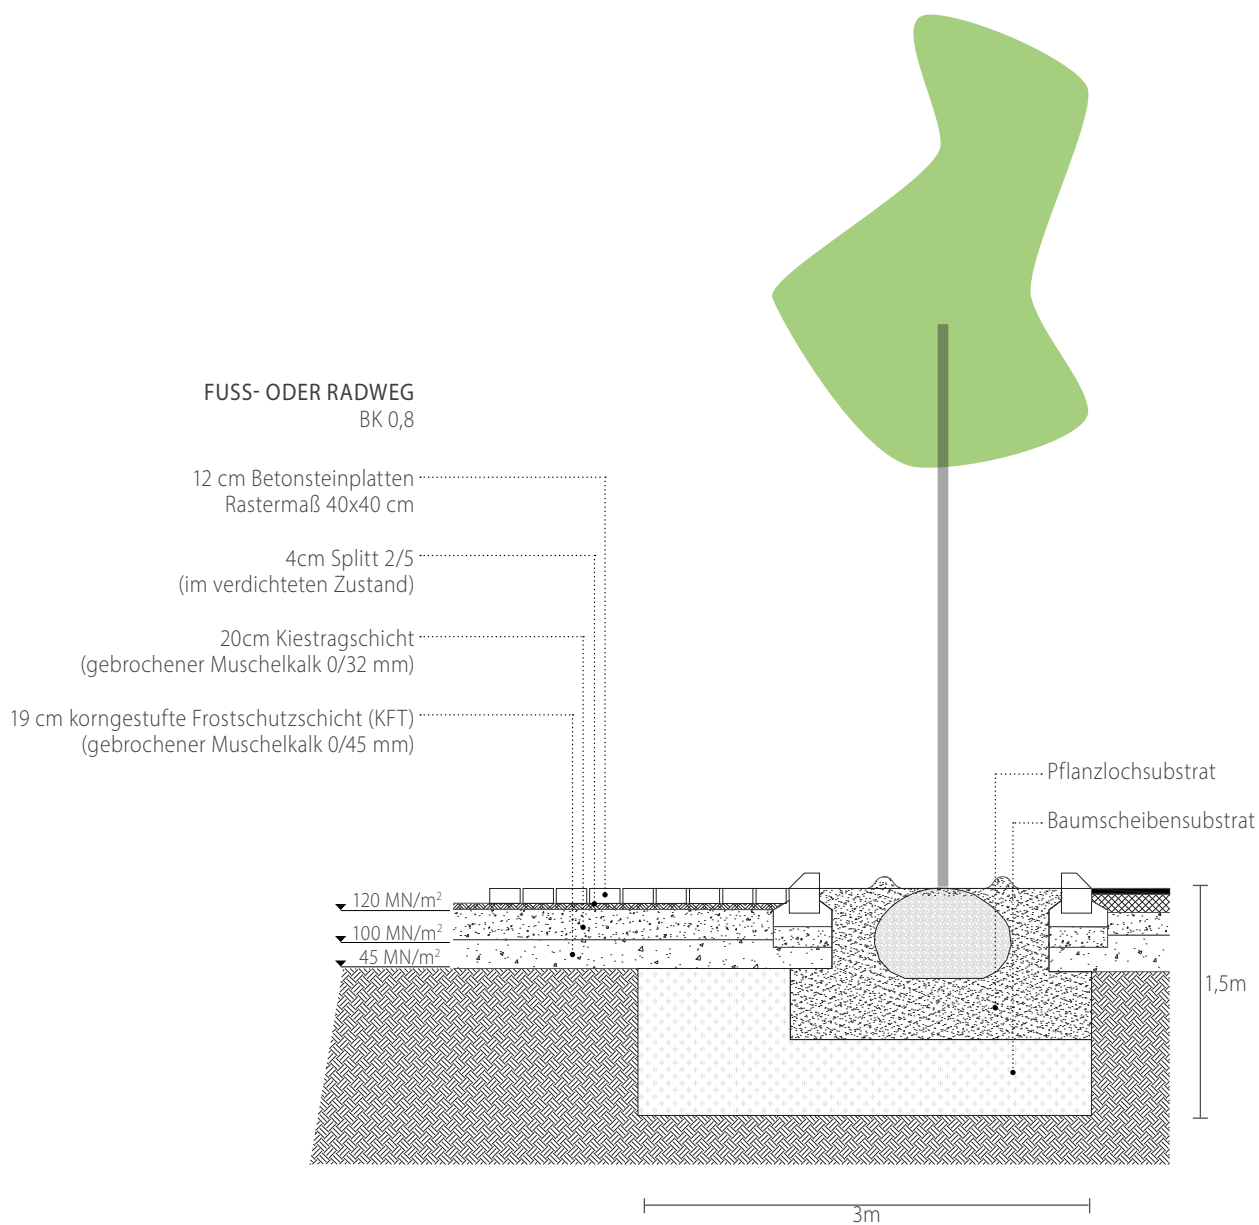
Detailsicht Bauweise 2: Schnittansicht A
